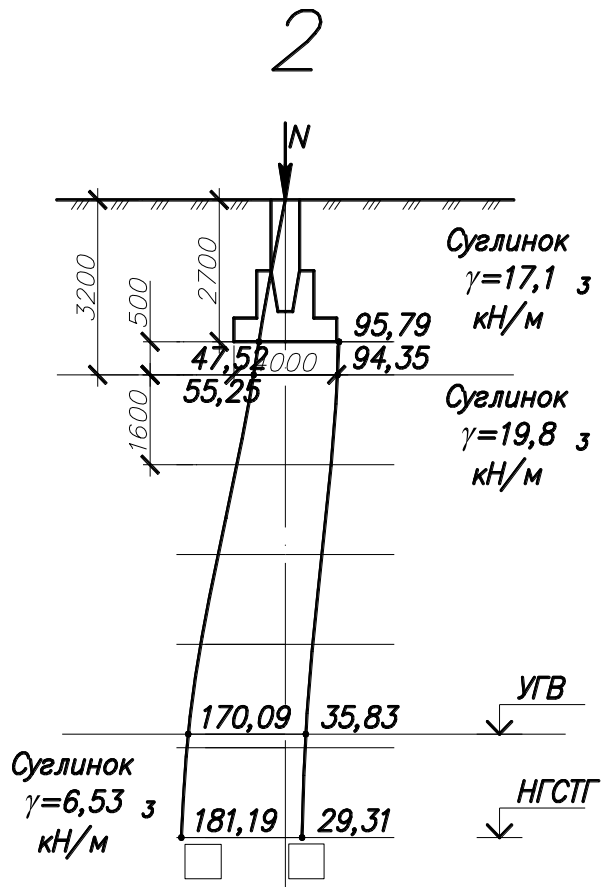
Осадка фундамента в сечении 2-2
